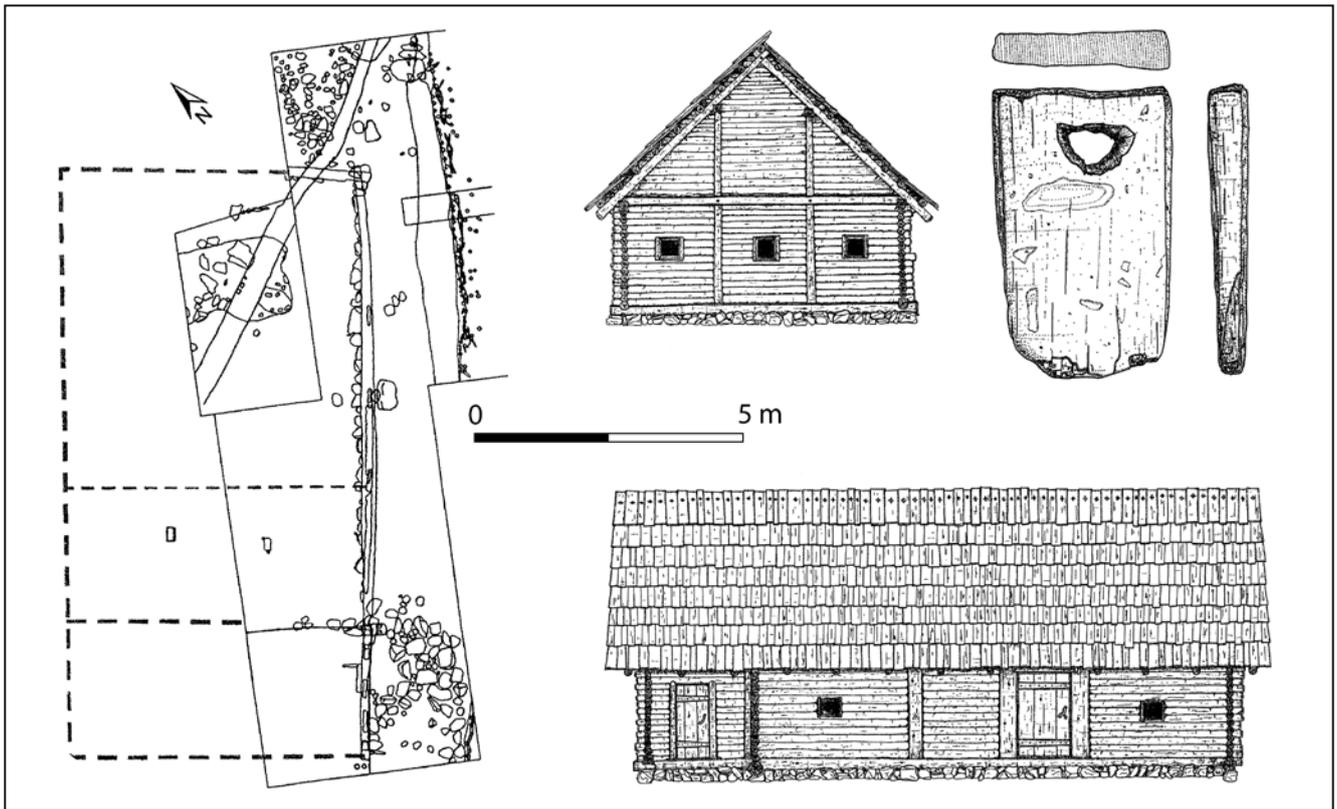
Grundriss, Rekonstruktion und durchbohrte Holzschindel eines frühlatènezeitlichen Hauses im Ramsautal des Dürrenbergs bei Hallein (nach Lobisser 2005: Abb. 32.76.77).
